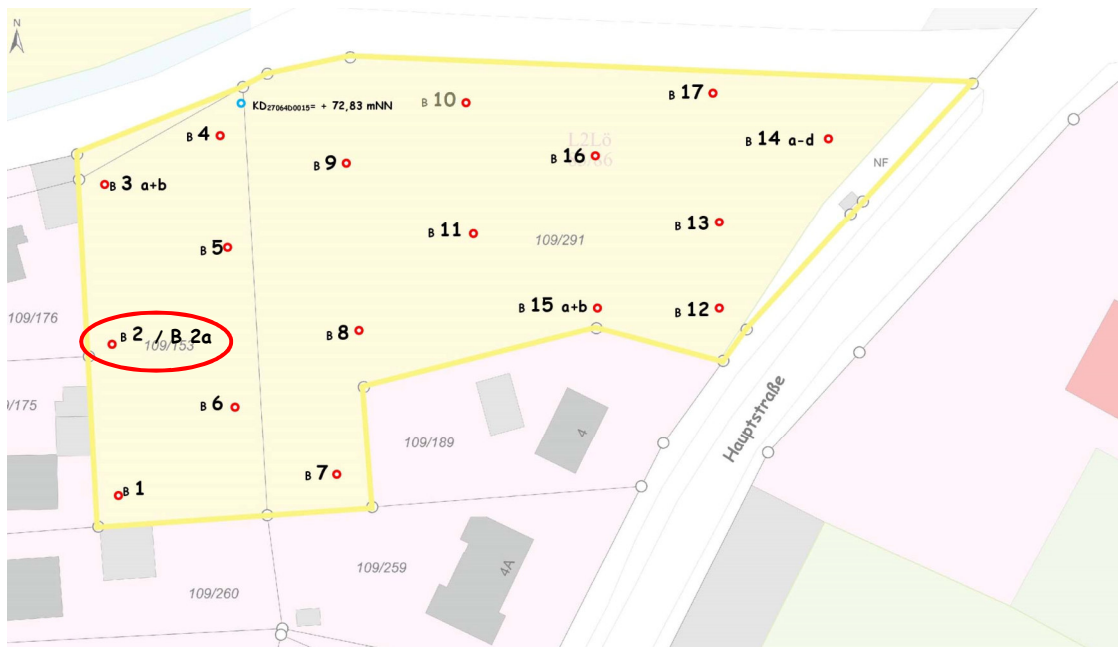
Bohrprofile und Lageplan der Bohransatzpunkte
